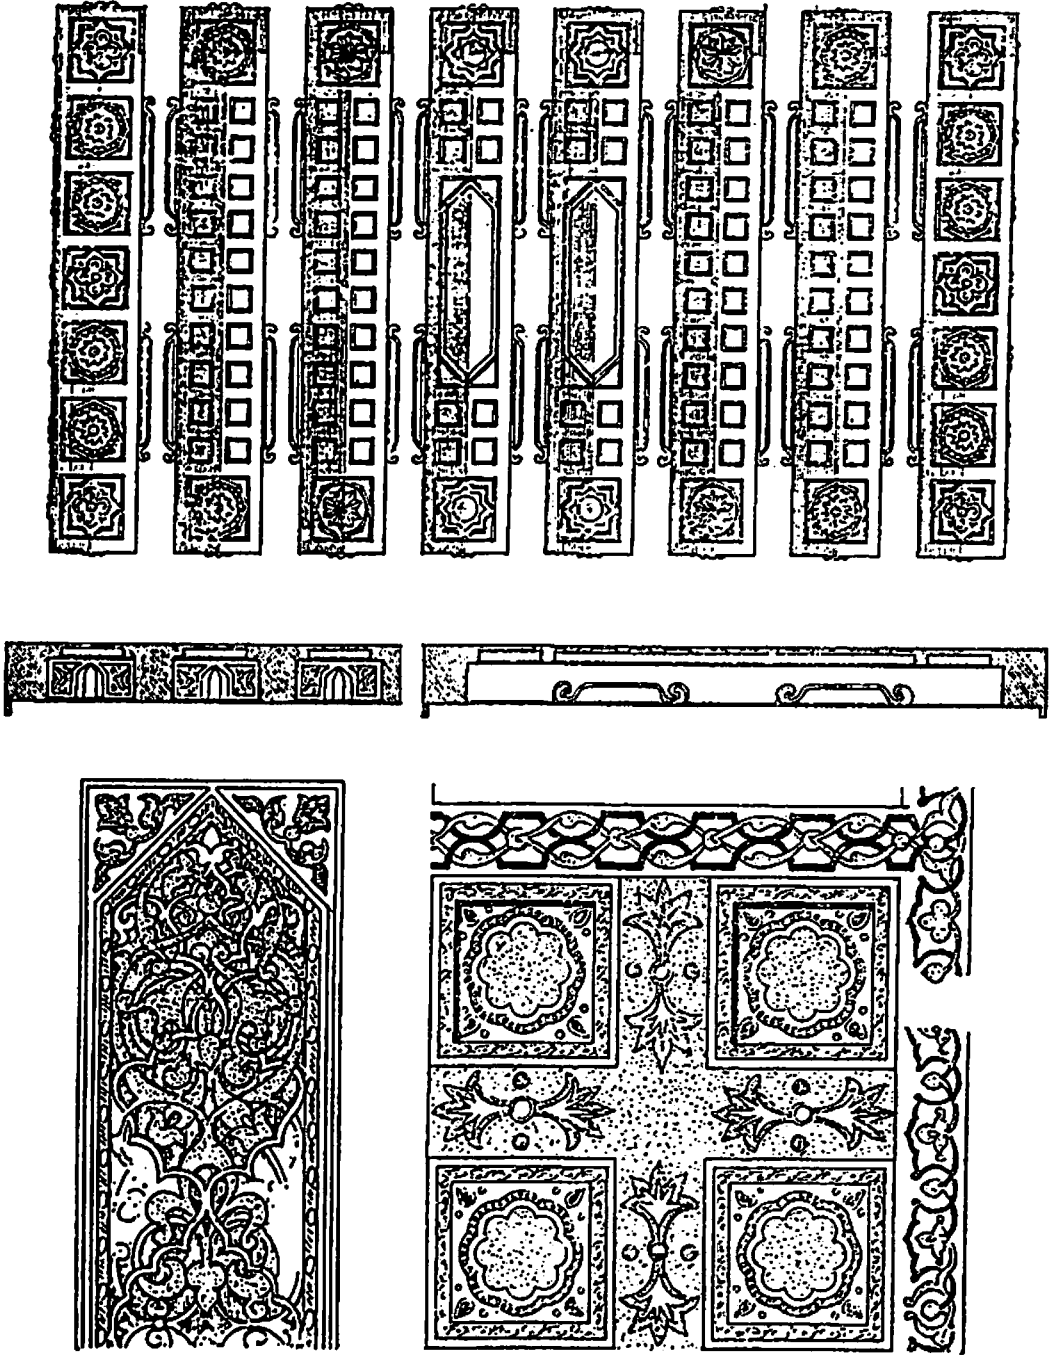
مسقط أفقي أرضية رخام جدار محل (تصميم المؤلف)
